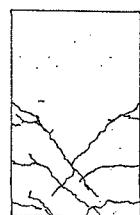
ひび割れ進行状況(H2-1, 10mm)
